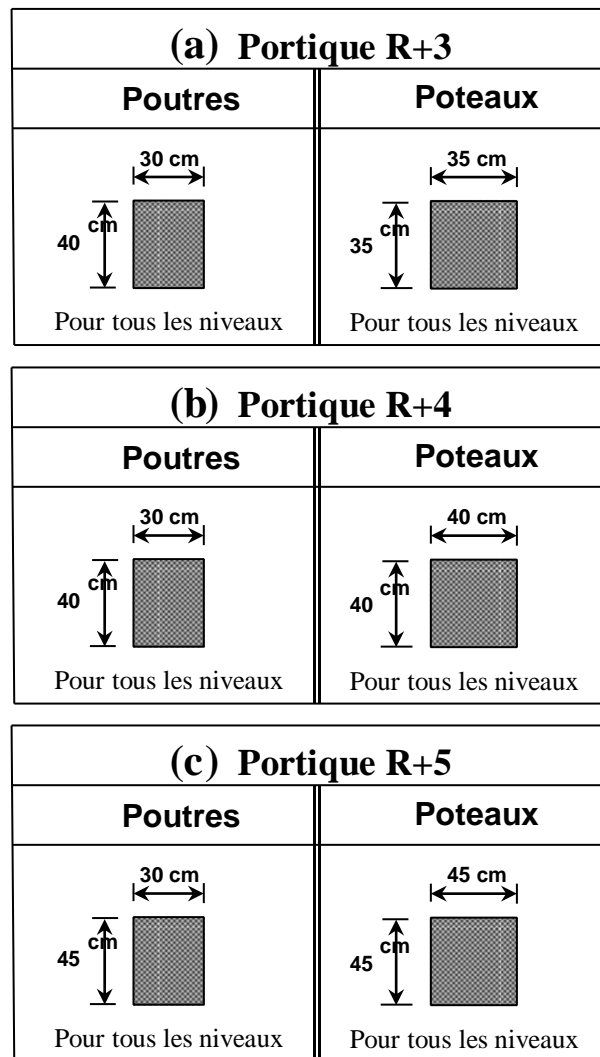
Dimensionnement des sections de béton des poutres et des poteaux des trois portiques étudiés
